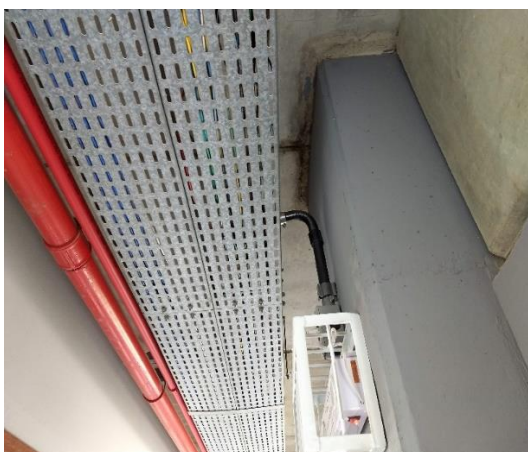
Eletrocalhas para cabos de alimentação em BT – 01/12/2020
